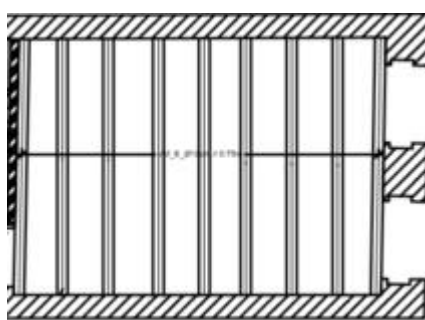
Planta estrutural do pavimento PVRA_5
